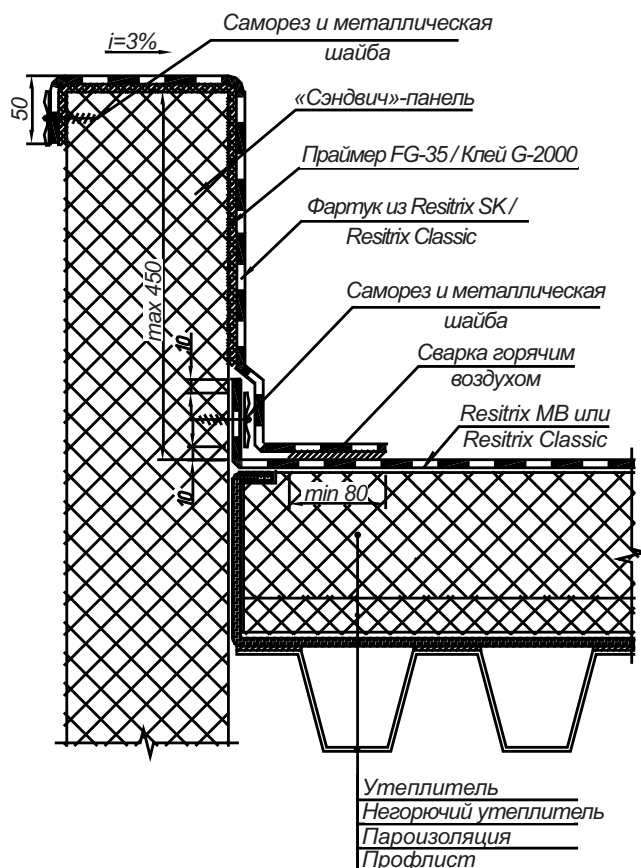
Примыкание кровли к парапету высотой менее 450 мм.
